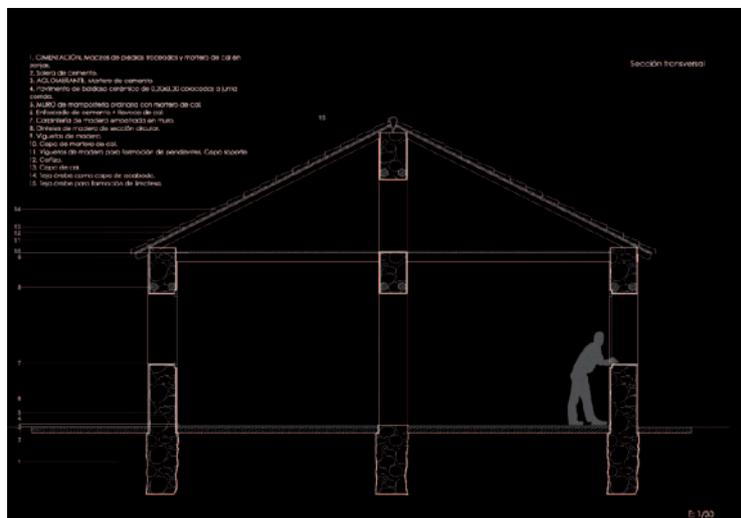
Sección constructiva Casa Grande. Elaboración Propia.
